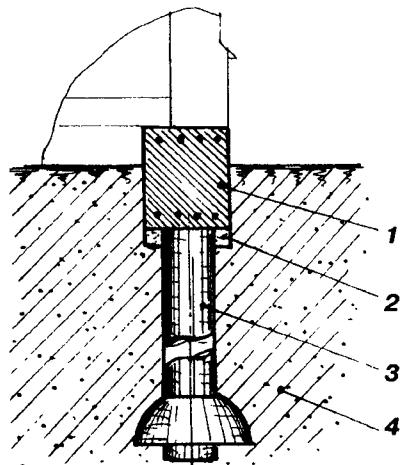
Разрушение опоры пучинистым грунтом при мелкозаглубленной ленте фундамента:
